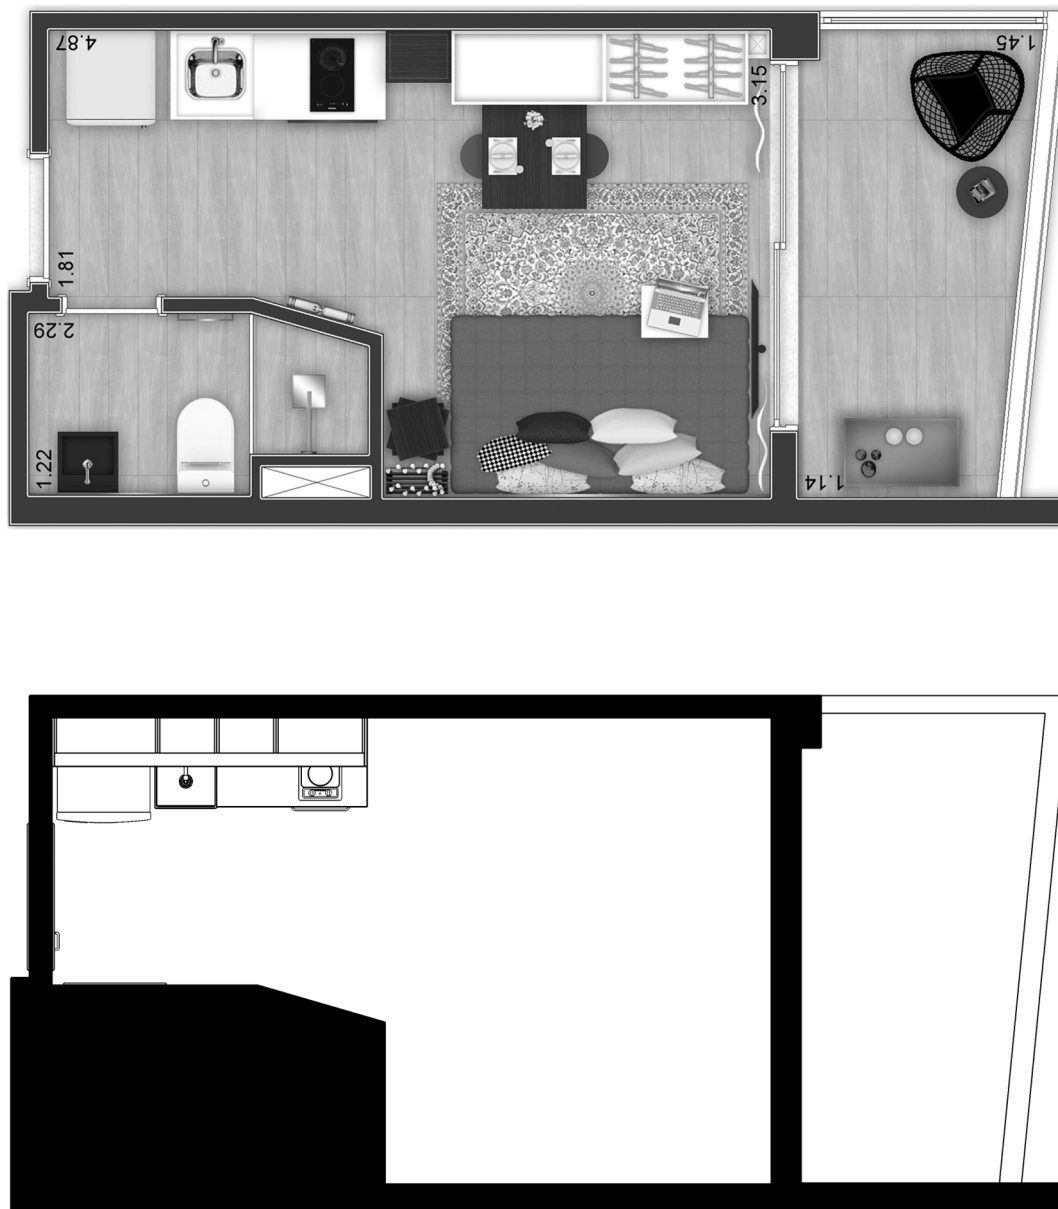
Acima: planta baixa do empreendimento Downtown Sé. Abaixo: planta baixa da simulação da instalação do sistema modular proposto. Fonte da imagem: acima disponível em www.setin.com.br (acedido fev. 2018) abaixo elaborada pelo autor.
